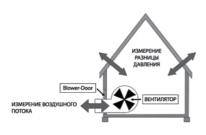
Схема испытания с использованием установки "blower door"
